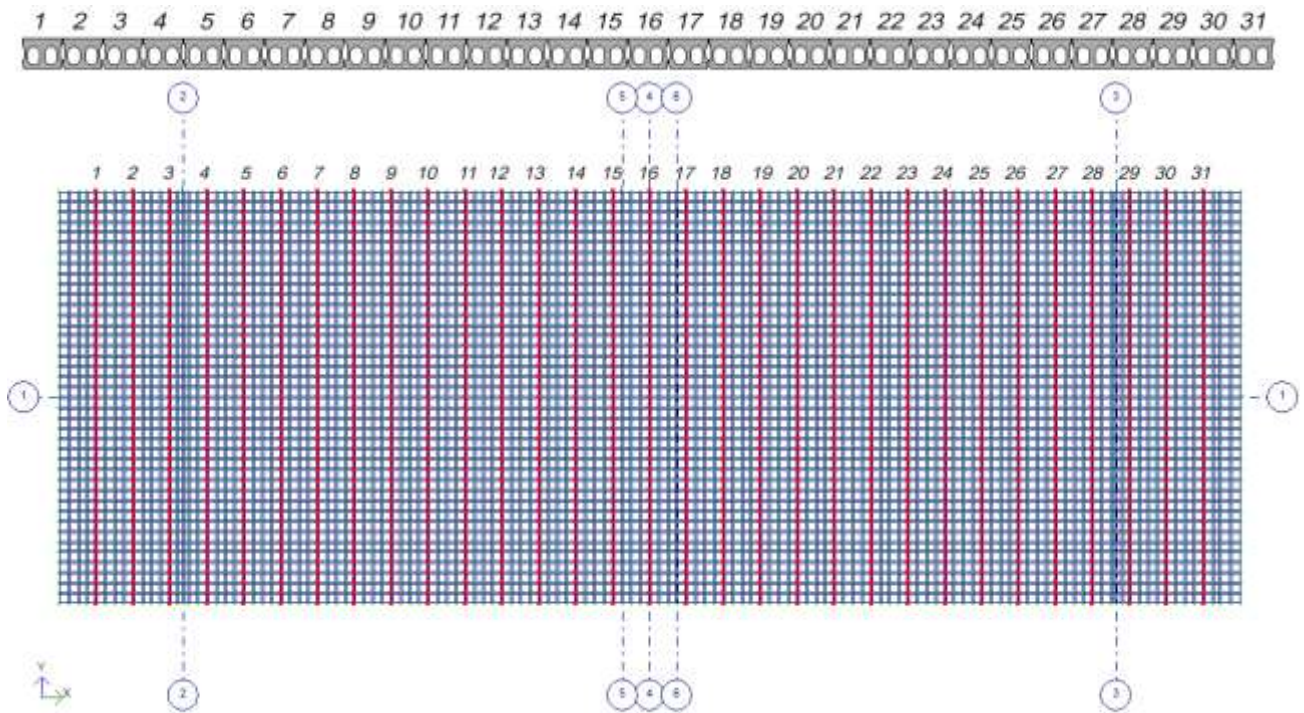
Расчетная схема пролетного строения в сечении и плане
